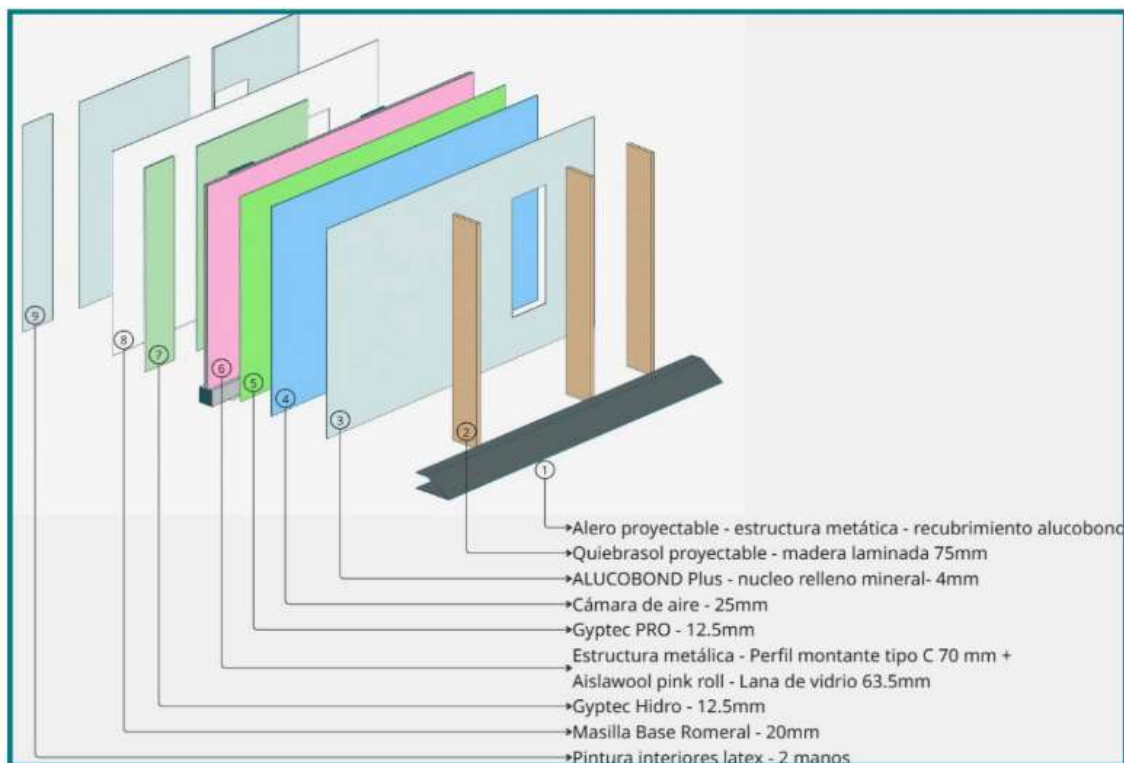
Detalle multicapa de tabiquería en fachada, Version 2
